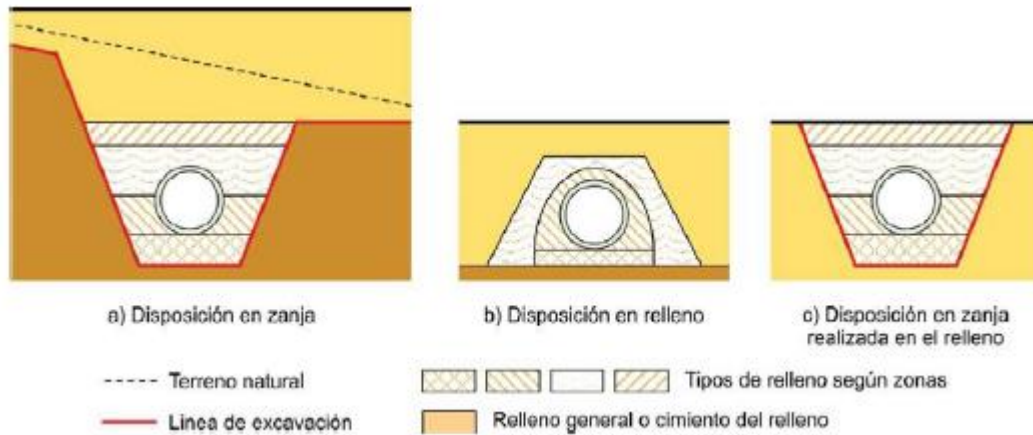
Sección transversal del encaje de la ODT en el terreno.
